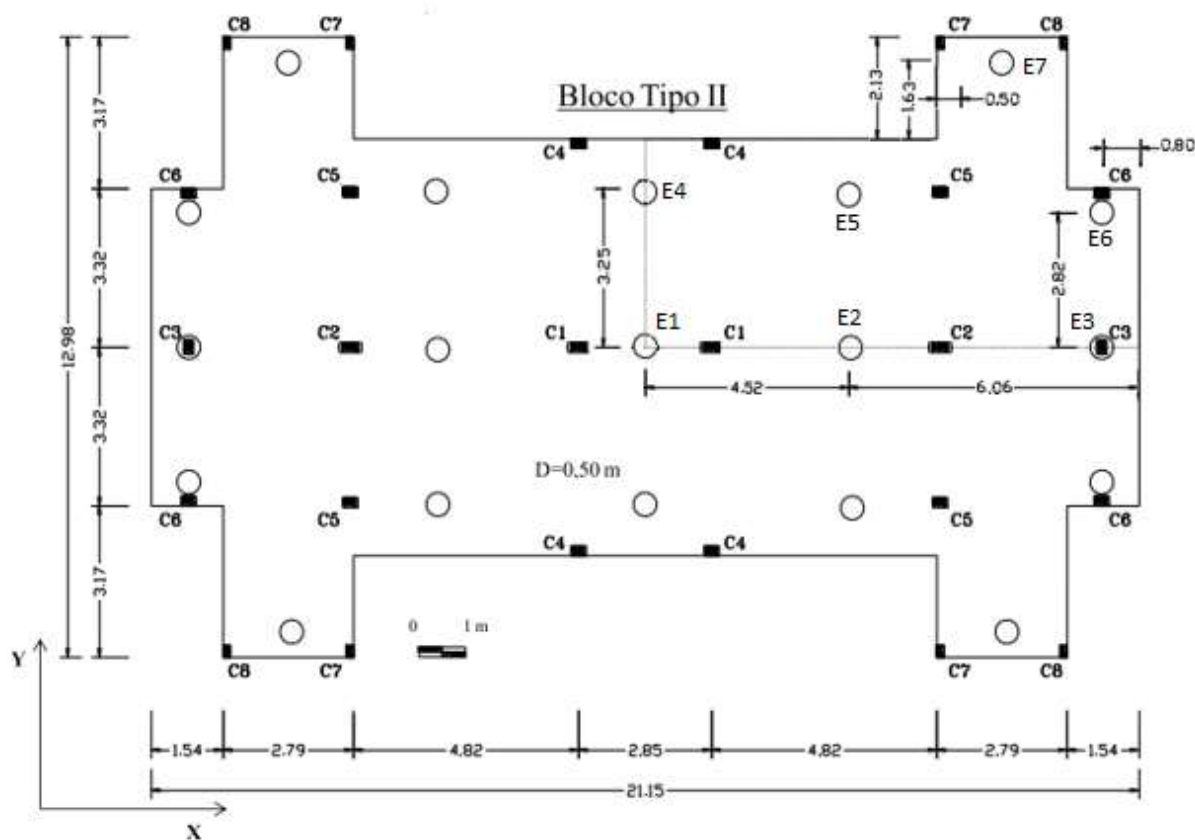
Vista em planta baixa do radier com 19 estacas para o bloco tipo II (Castillo, 2013).
